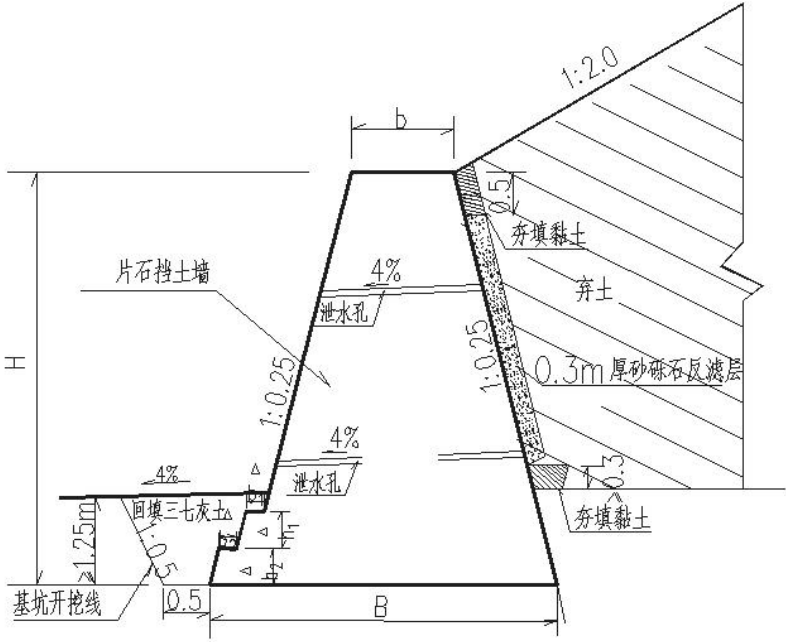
挡渣墙断面图（C25 片石混凝土）
